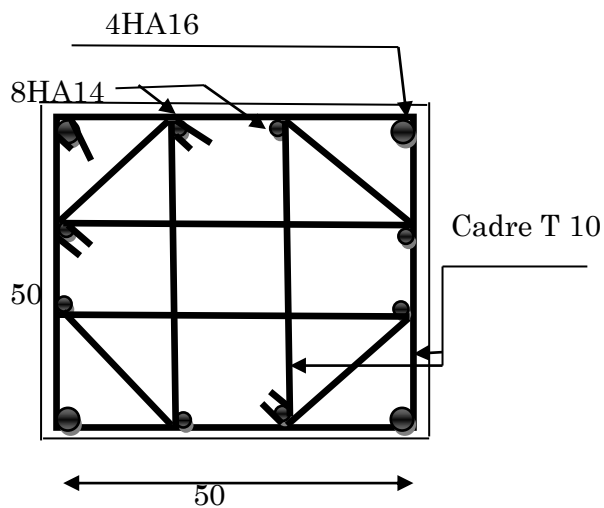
Schéma de ferrailage des Poteaux d'entre sol 1 et 2
